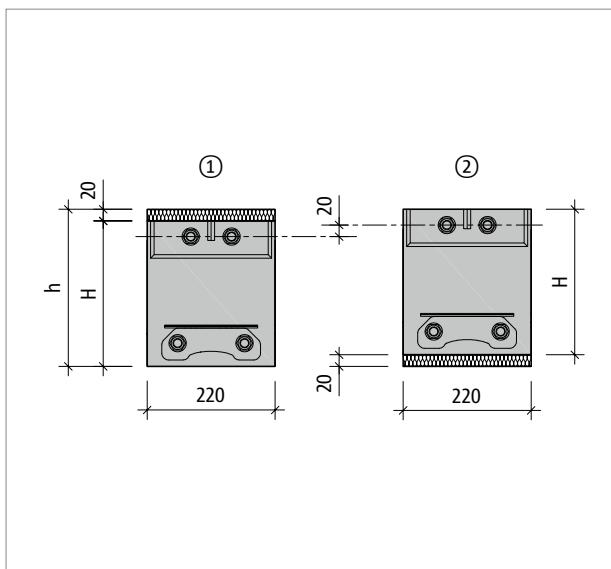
Schöck Isokorb® XT type SK : disposition avec décalage en hauteur
